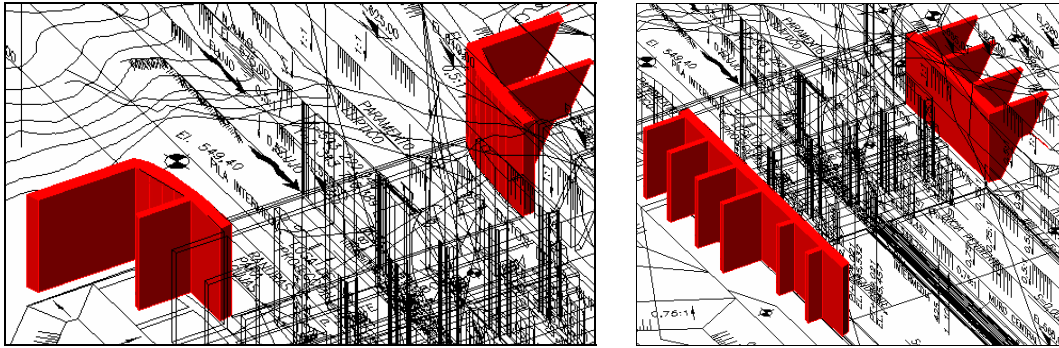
Procedimiento de construcción de las pilas centrales
